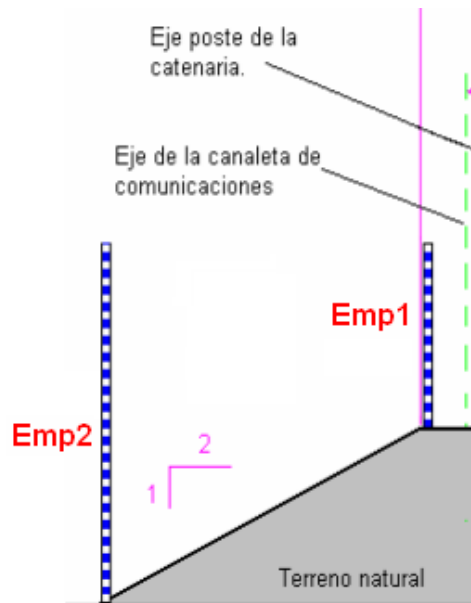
Posibles emplazamientos de la barrera en terraplén.
